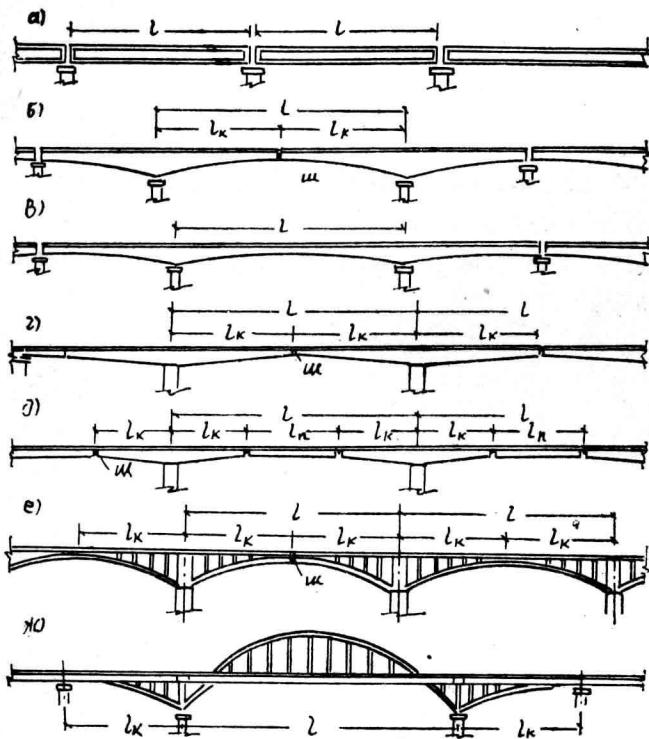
大型公路桥和城市桥钢筋混凝土上部构造图式
